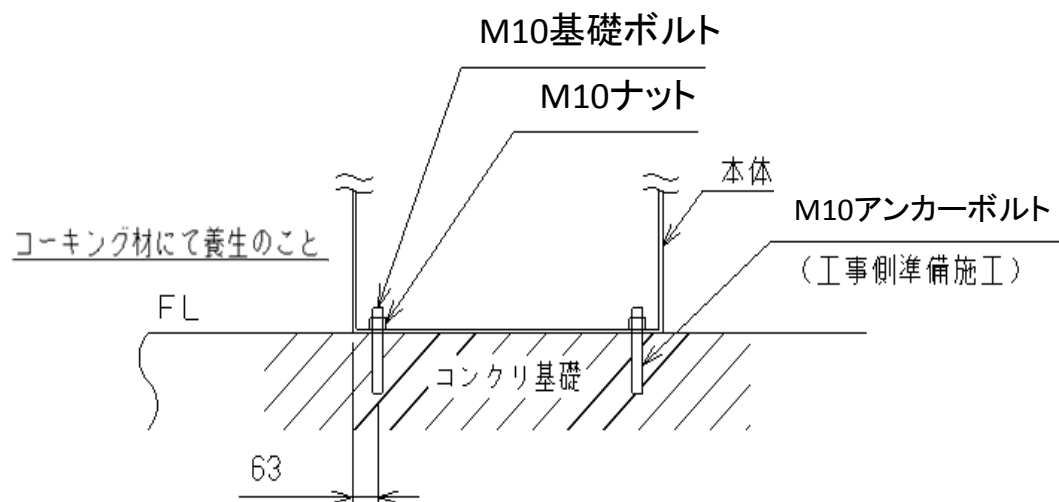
アンカーボルト取付基礎ボルト埋込方説明図2
